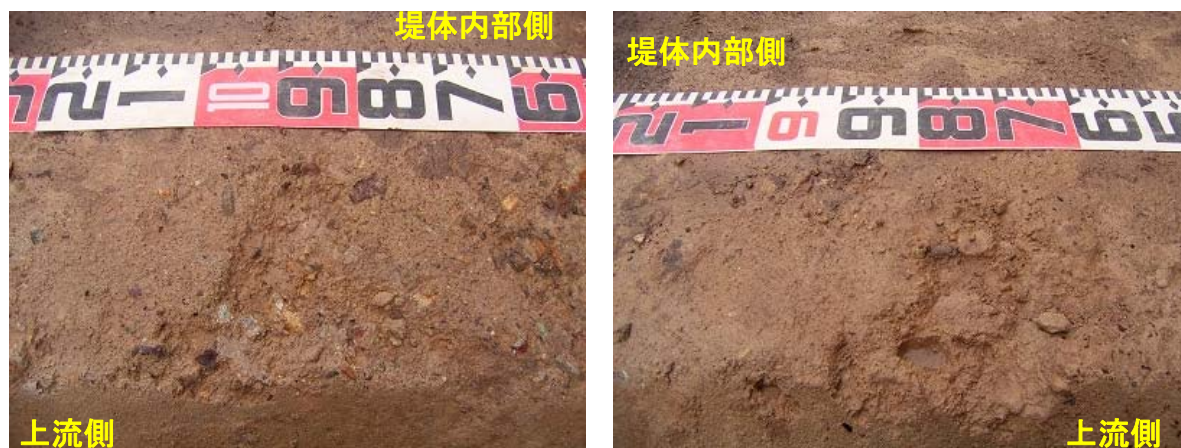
付加断面上流側隅角部の摩耗劣化状況
